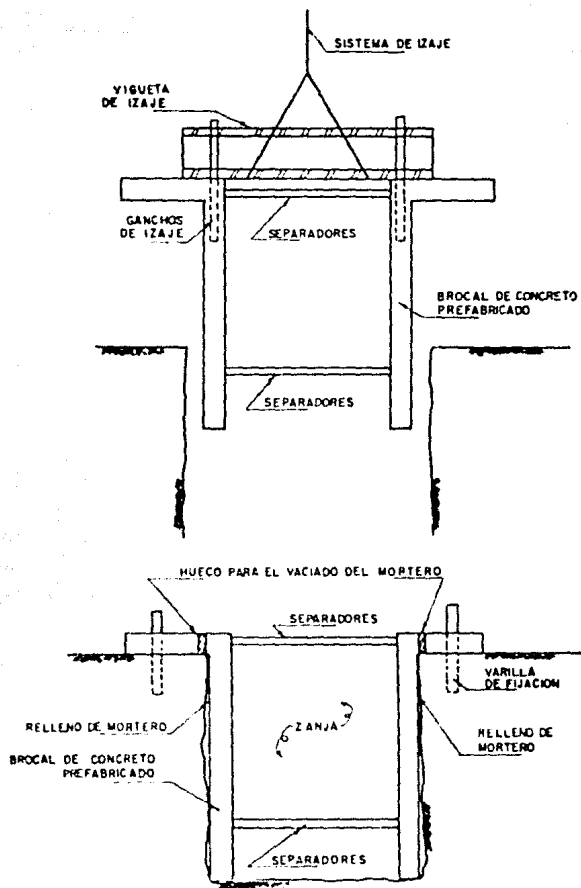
COLOCACION DE LOS BROCALES DE CONCRETO PRECOLADO
